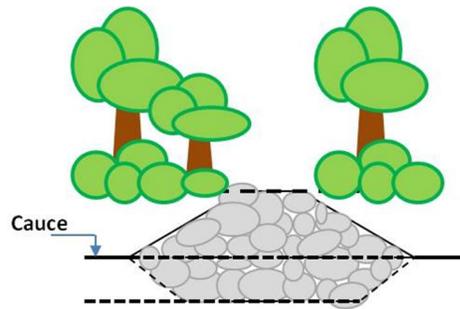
Esquema de protección con espigones, corte longitudinal, no a escala
